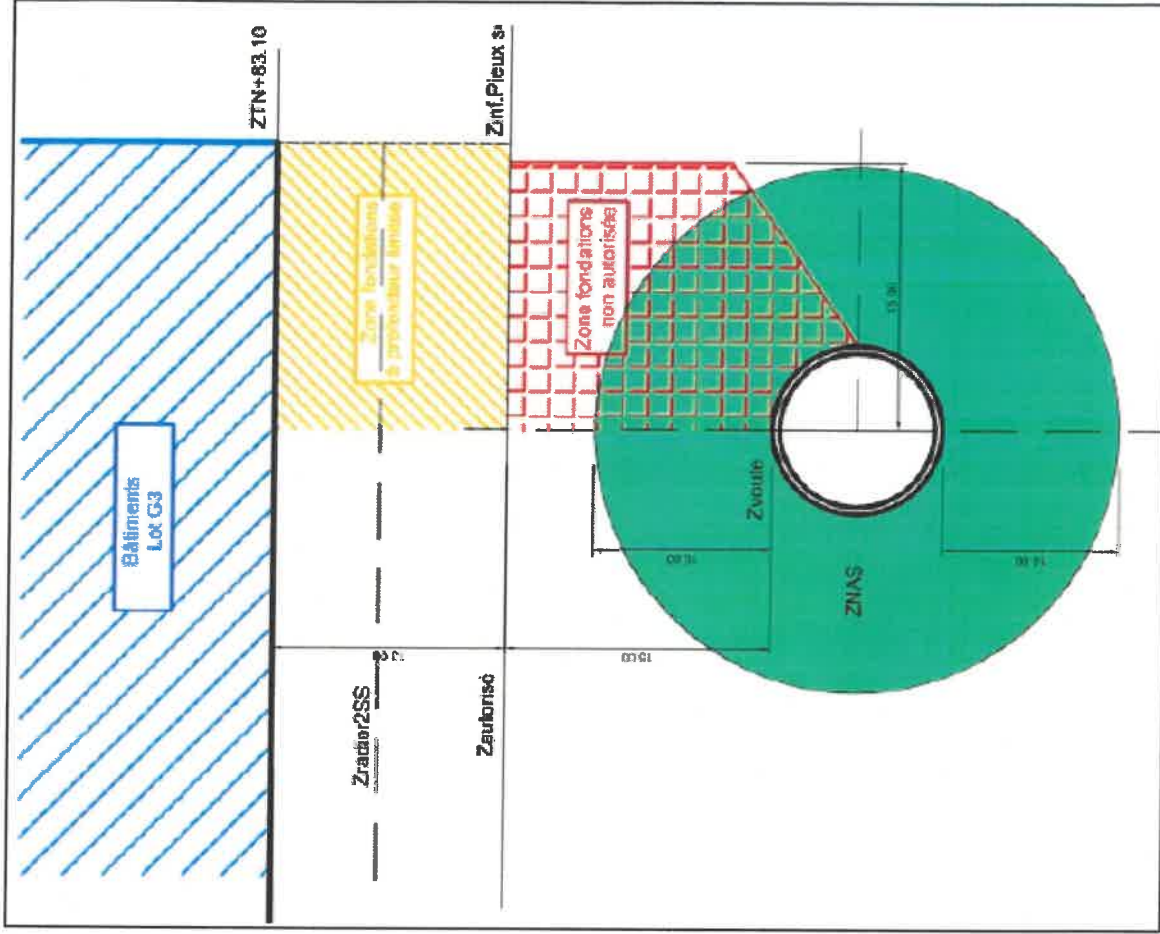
Coupe Schématique au droit du projet de bâtiment et zones non autorisées aux fondations et sondages géotechniques pour reconnaissance de sols
